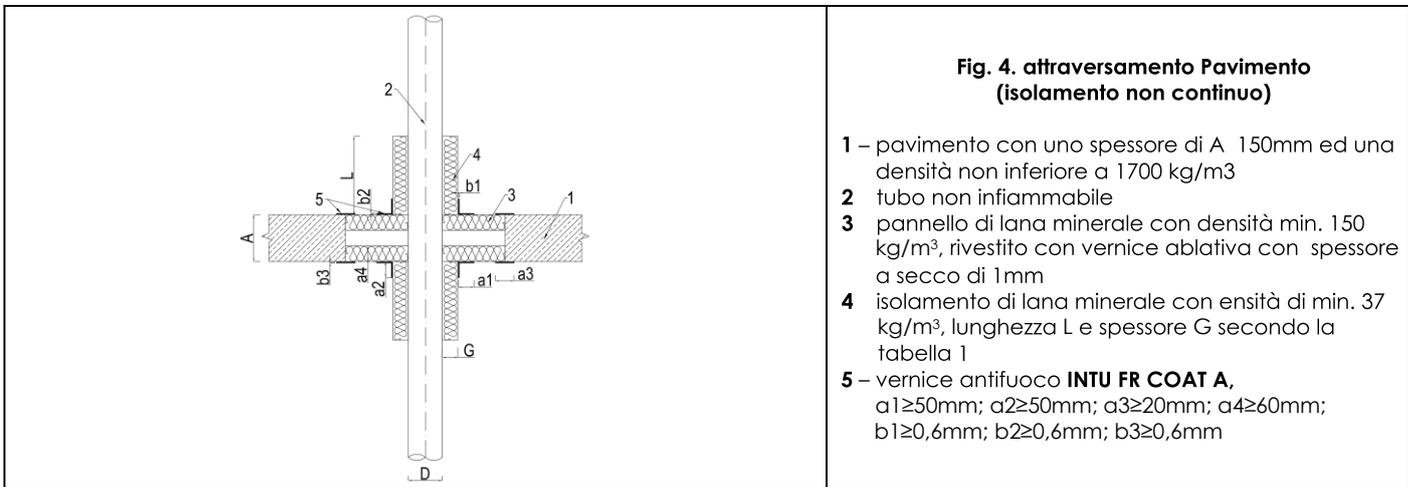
attraversamento Pavimento (isolamento non continuo)
